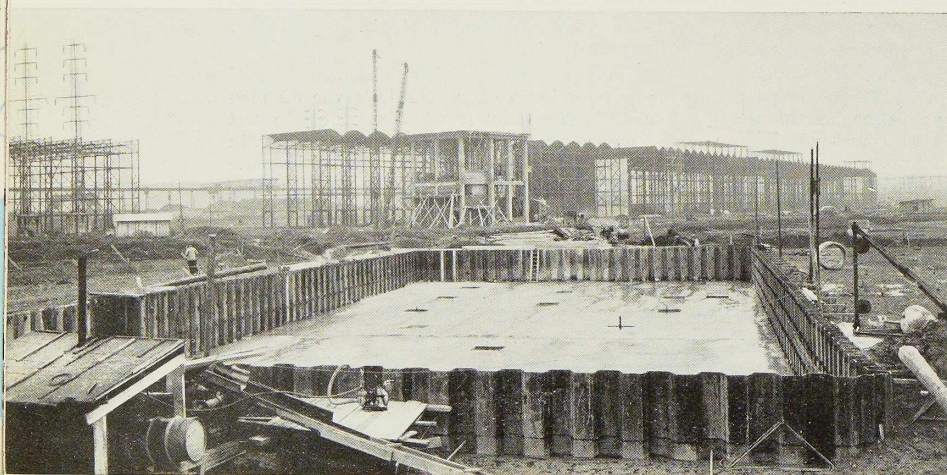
Vue prise en novembre 1938. Au premier plan, les parois en palplanches métalliques de la future piscine olympique du Lido. A l'arrière-plan, les charpentes standard des palais de la Section belge.
